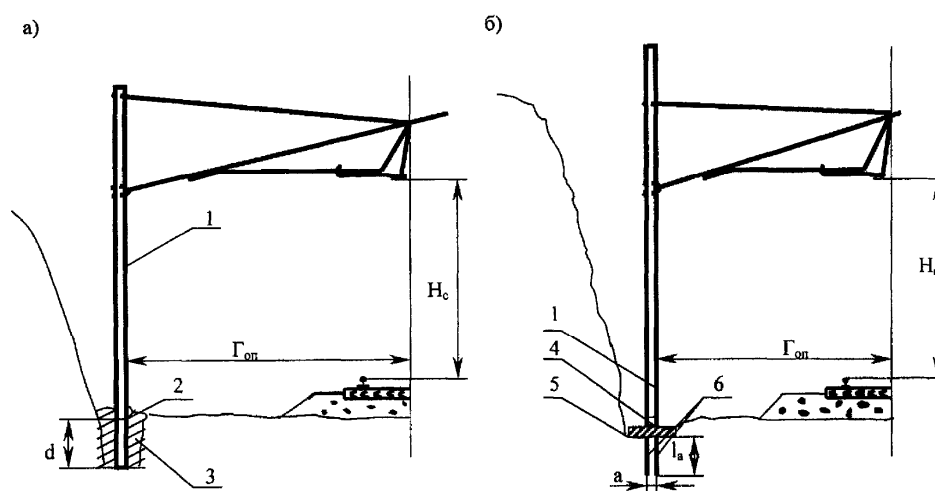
Схема установки опор в скальном грунте: а - с разработкой котлованов; б - с помощью анкерных болтов;
